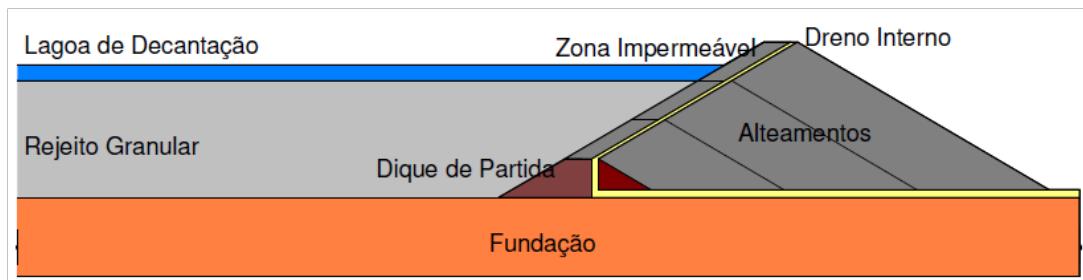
Seção de um alteamento para montante sobre barragem existente.
